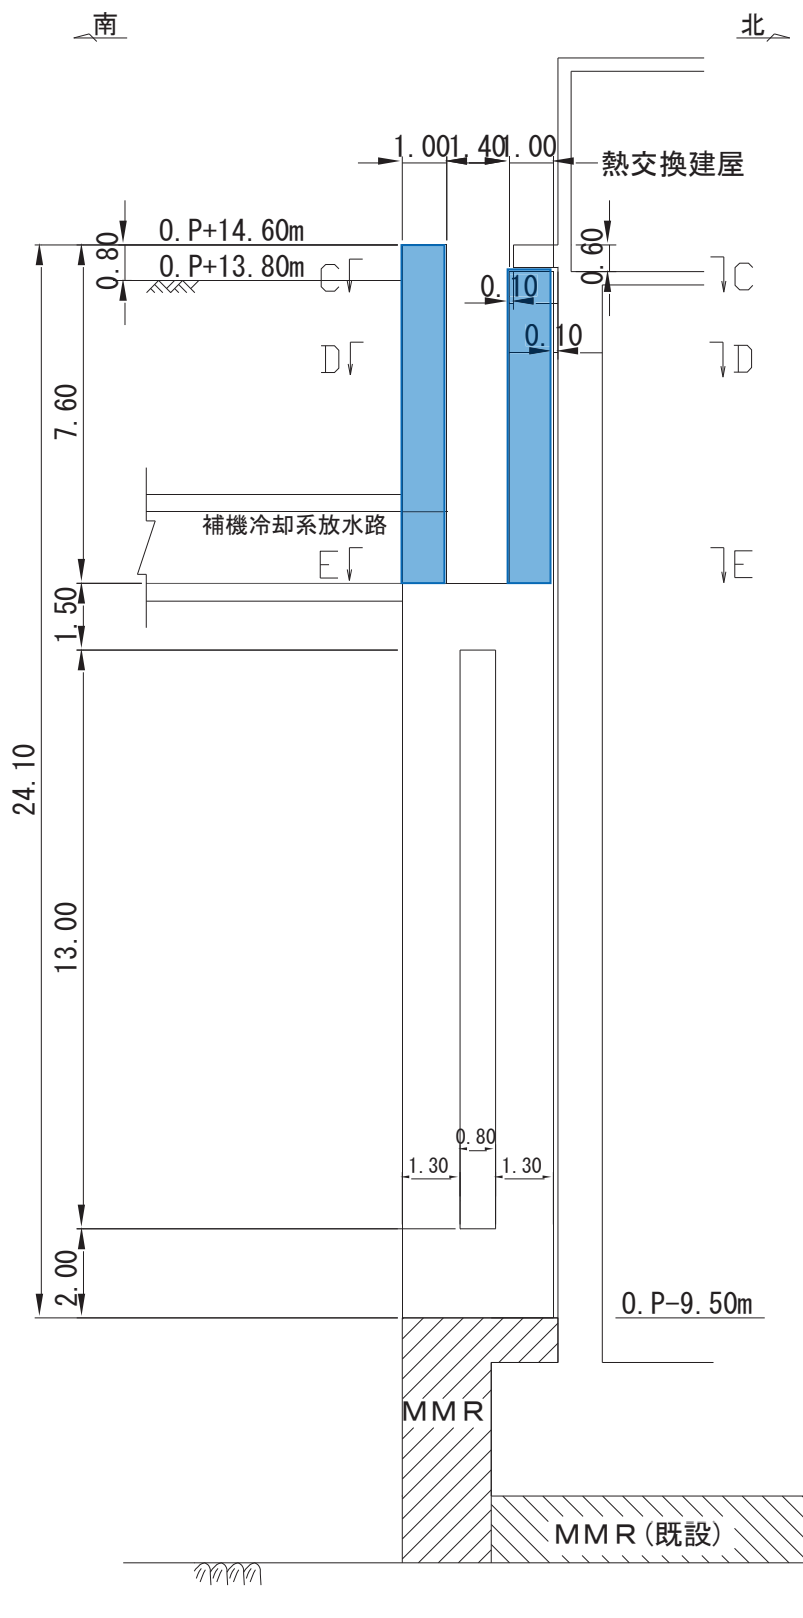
第3号機補機冷却海水系放水ピット平面図
